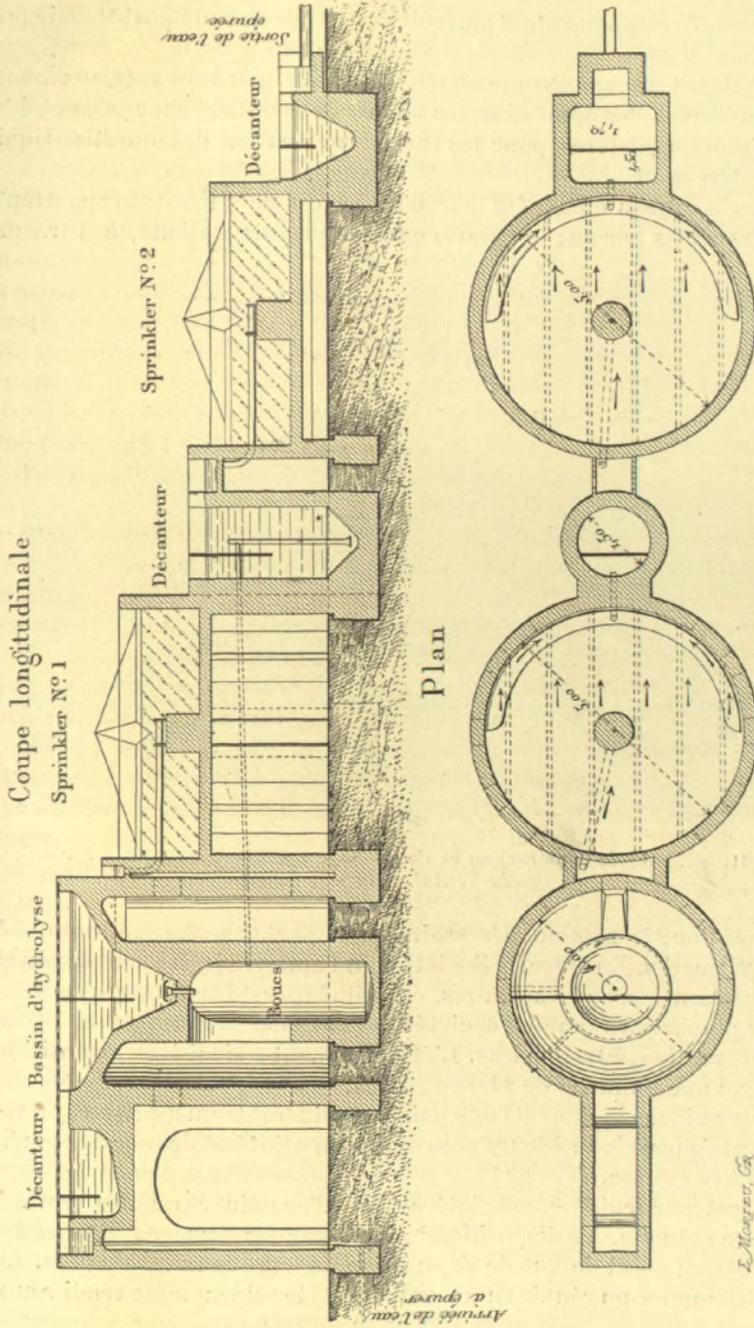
Schéma d'une installation d'épuration par sprinklers type Candy-Wittaker.
